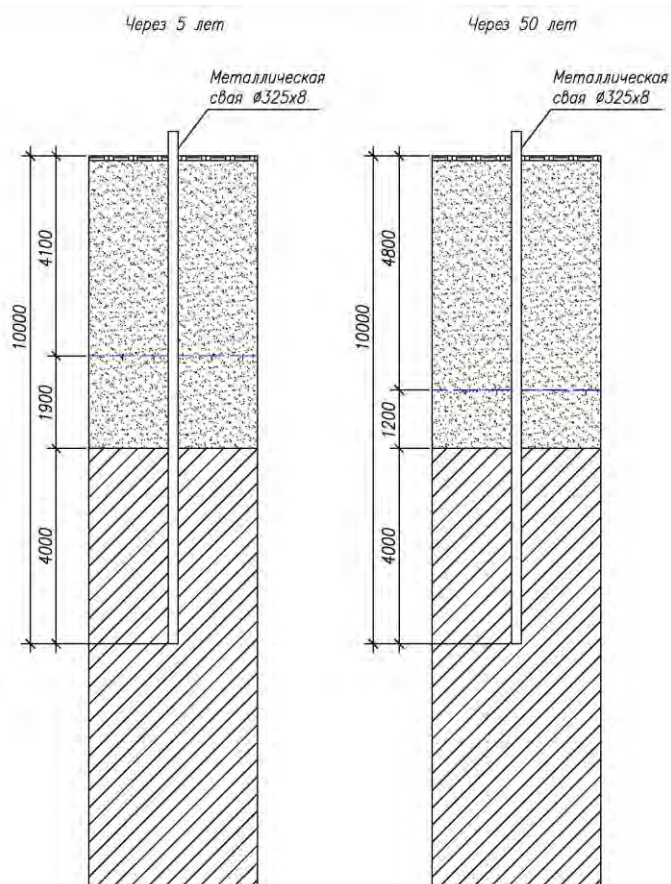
Расположение сваи фундамента длиной 10 м в грунте (для Варианта 2 расчета).
